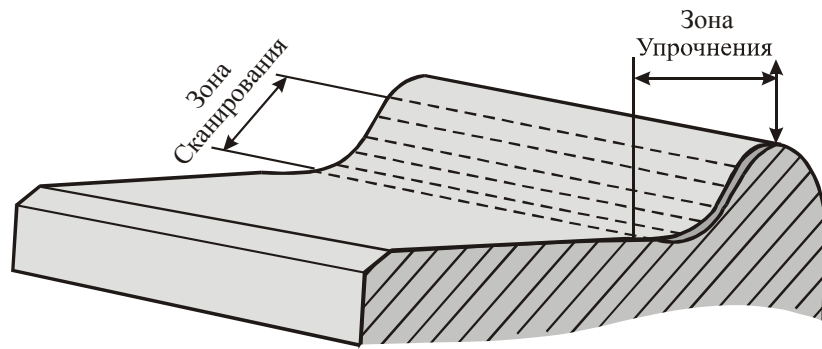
Зона контроля, вершина и рабочая поверхность гребня бандажа
